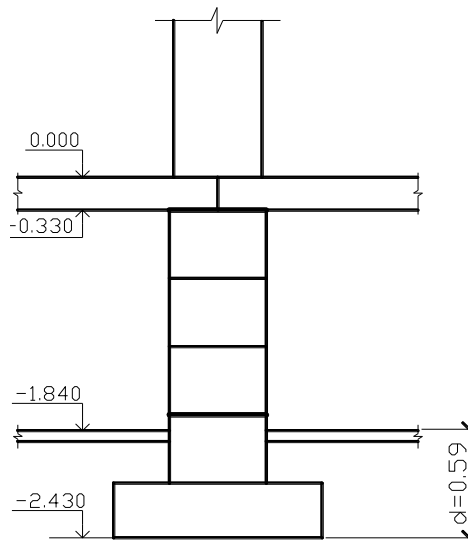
Конструктивне вирішення стрічкового залізобетонного фундаменту
